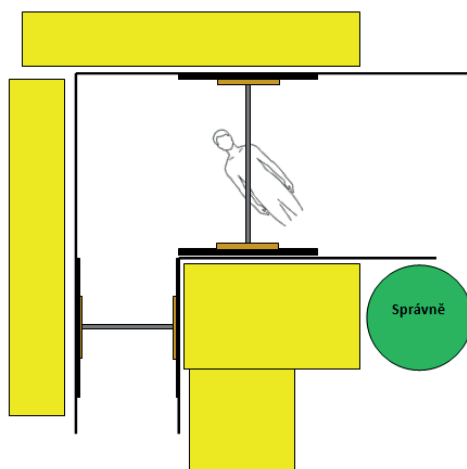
, Základní stabilizace výkopu tvaru "L" [7]
